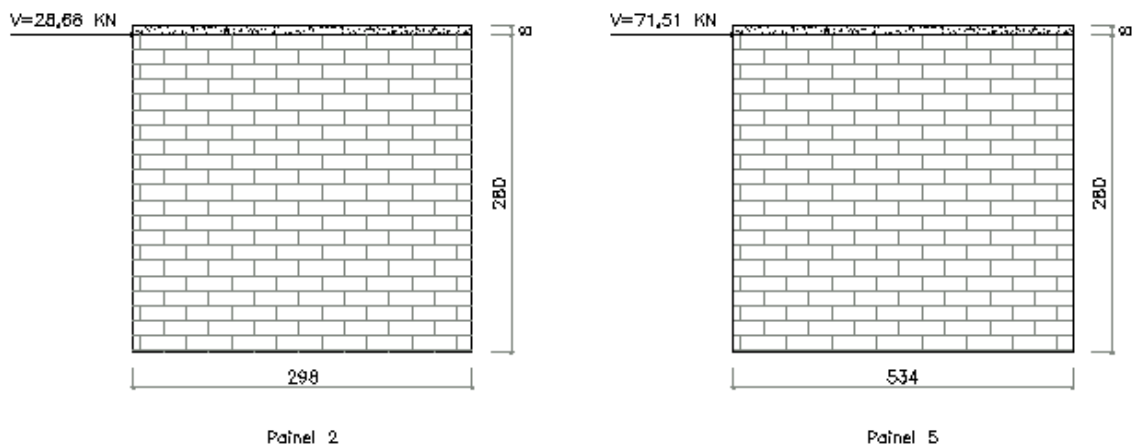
Painéis 2 e 5 – 1º pavimento
